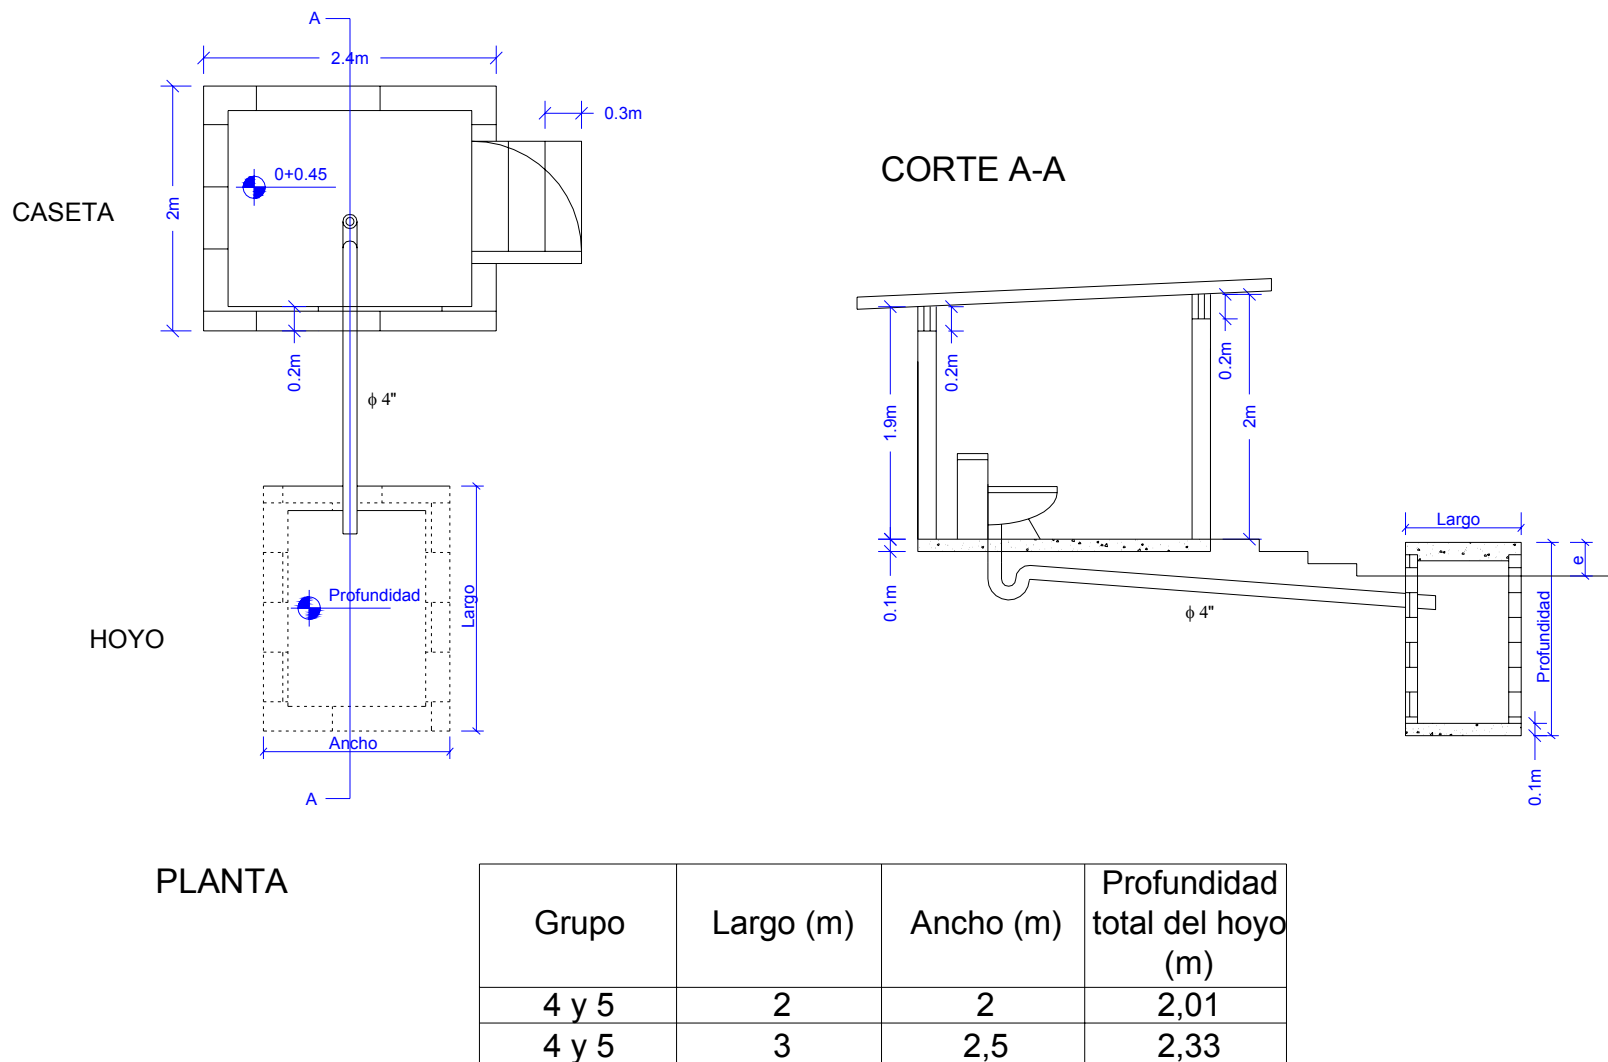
Sistema 2 - Letrina de hoyo único con cierre hidráulico
